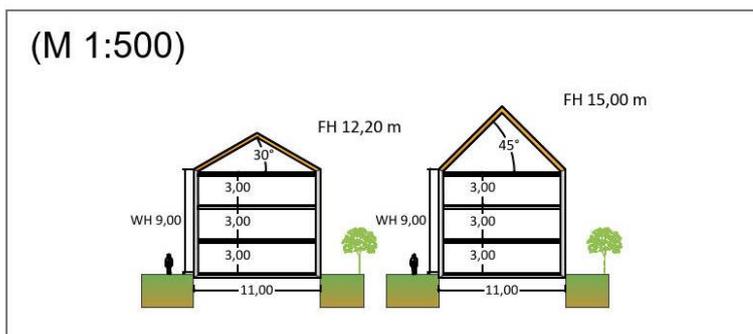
skizzenhafte Darstellung der Haustypen Typ C, jeweils nur mit Satteldach und einer Dachneigung von 30°-45°
